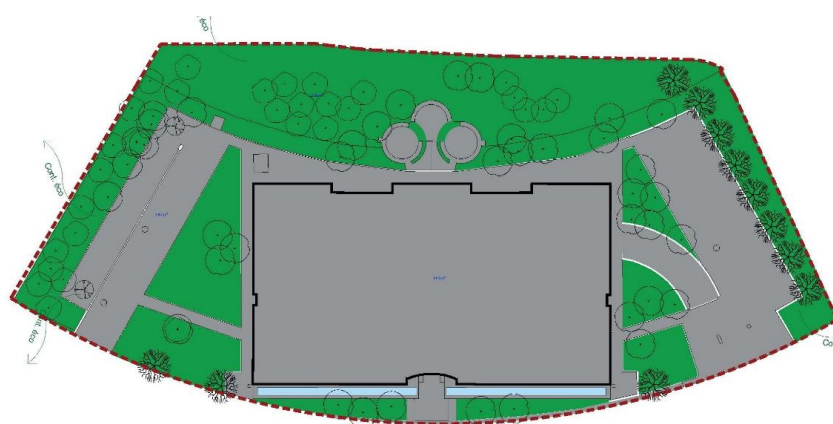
Extrait du plan d'implantation de la situation existante (source : ARTER Architects)
